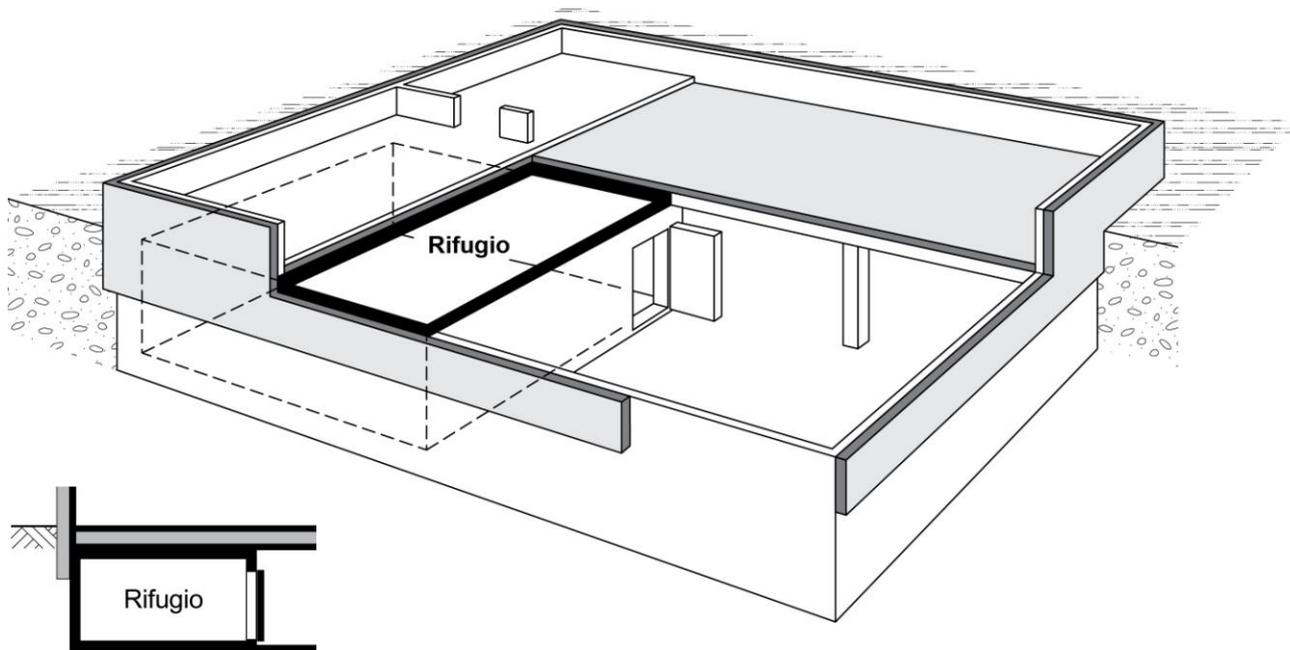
Isolamento di tutta la soletta del piano interrato
